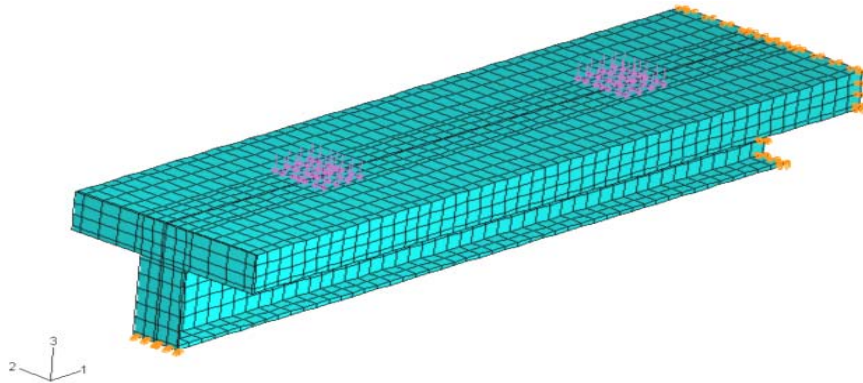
Vista Geral do modelo numérico M-F1: viga de aço e laje de concreto (discretizada com o elemento sólido $C3D8R$).
